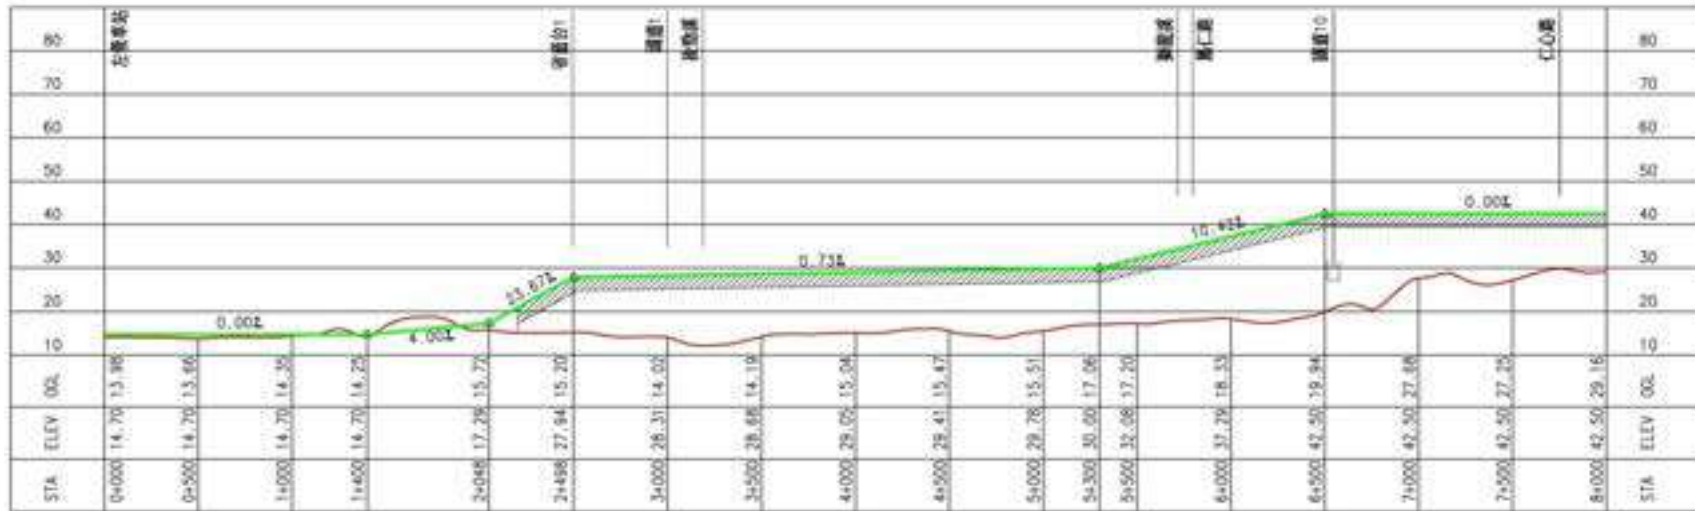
方案二-1 平縱斷面示意圖(1/3)
